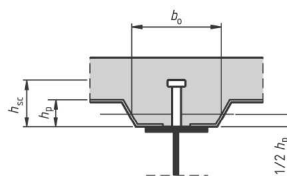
Träger mit parallel zur Trägerachse verlaufenden Profilblechen
